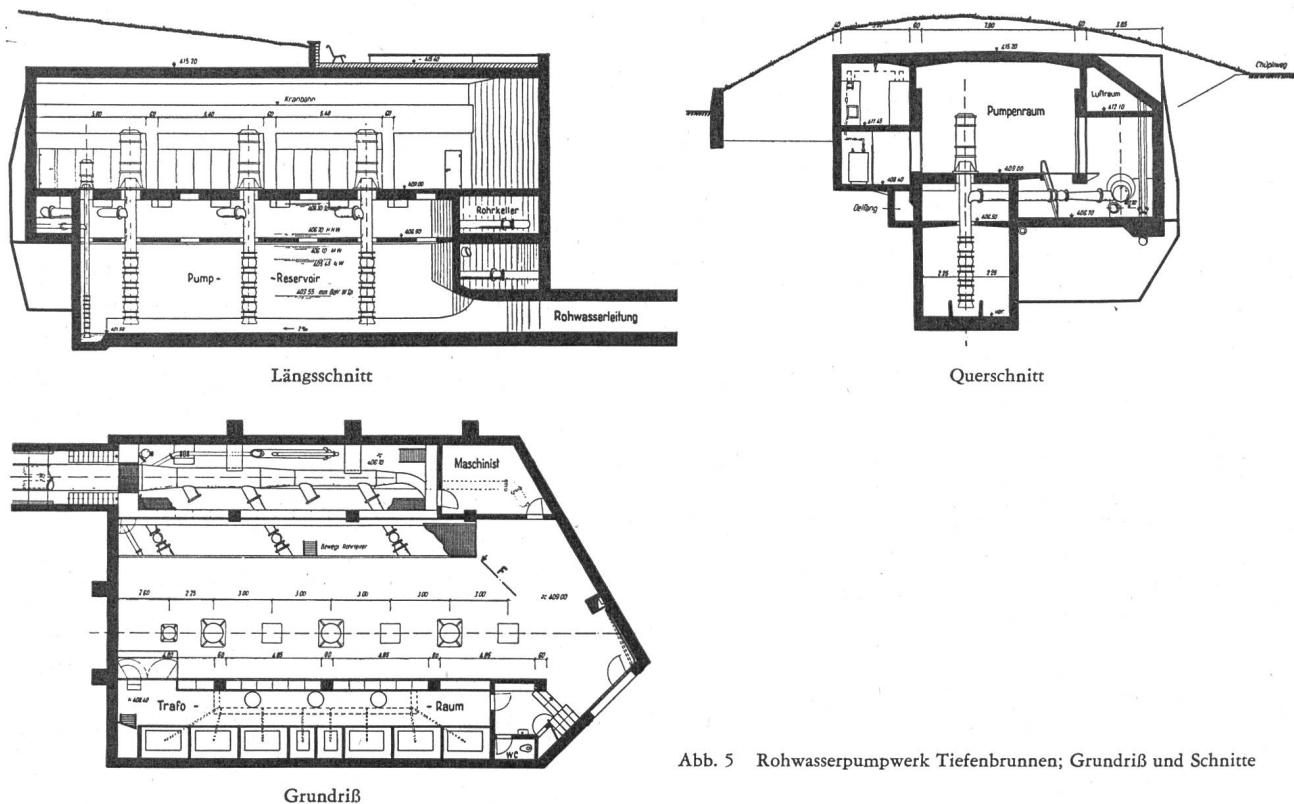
Rohwasserpumpwerk Tiefenbrunnen; Grundriß und Schnitte
